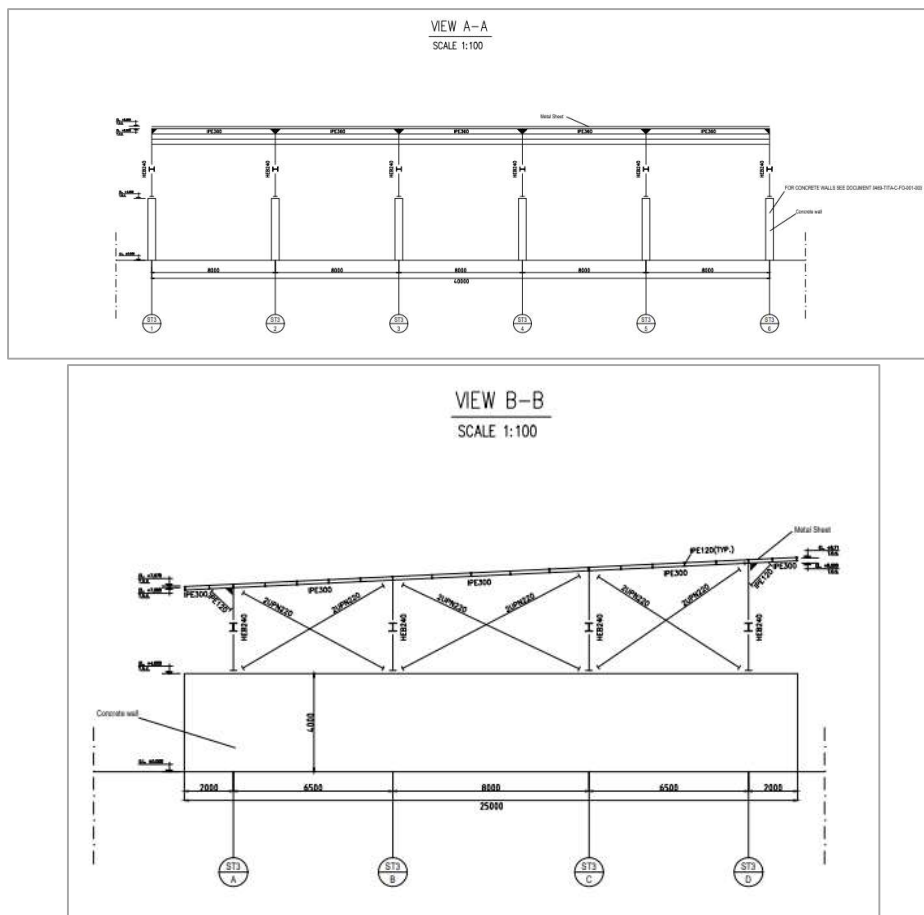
Estratto progetto zona carico autocisterne – muri di separazione e struttura di copertura
